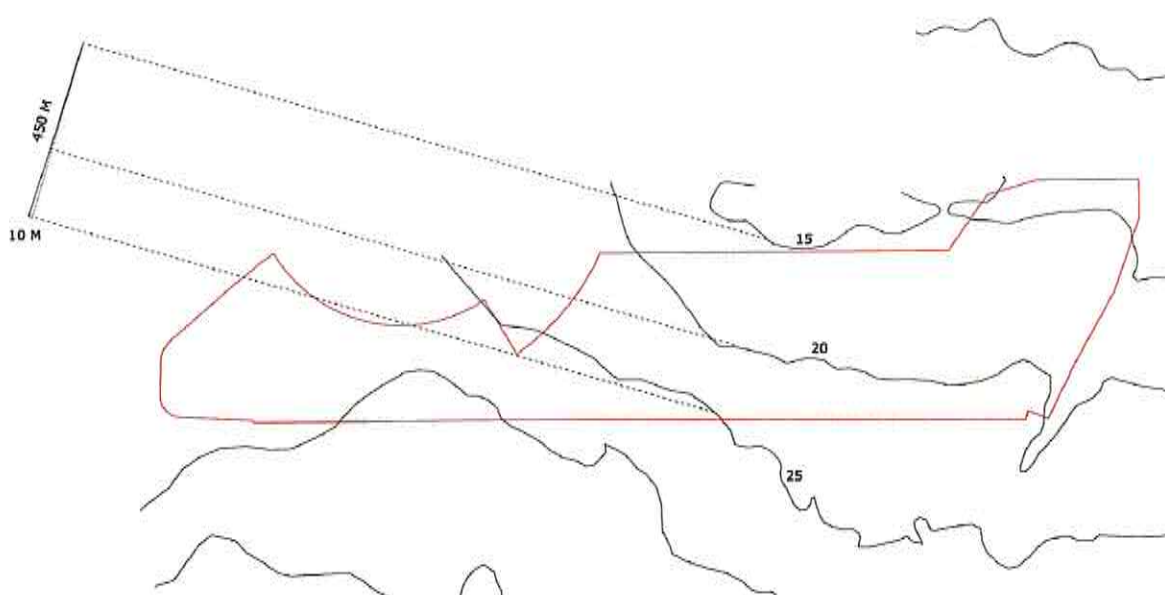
Il perimetro dell'area di intervento e l'andamento altimetrico del suolo: nella sezione di maggior ampiezza (pari a 450 m), il dislivello massimo si attesta sui 10 m (da +25 a +15 m s.l.m.)
